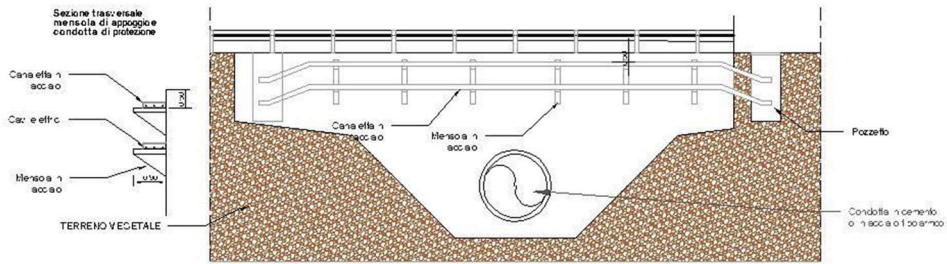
Particolare sezione tipo cavo interrato MT e particolari della sezione stradale
